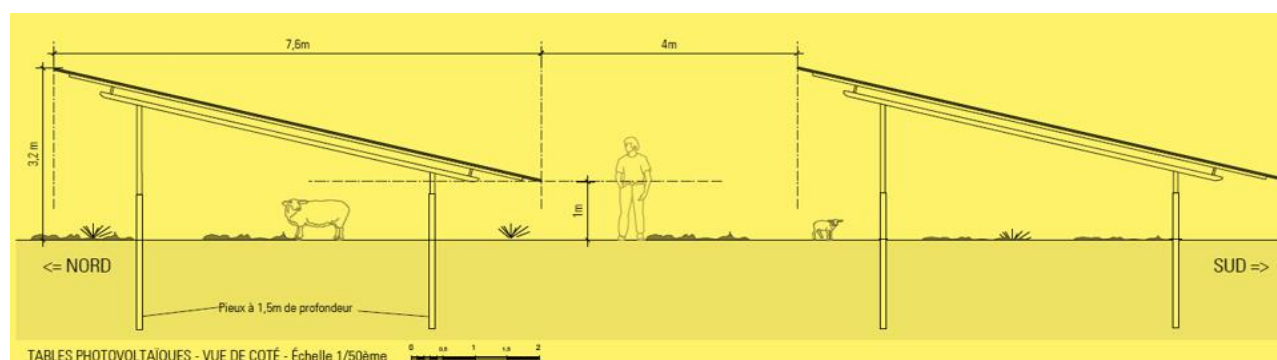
Plans de coupes et façades des tables photovoltaïques
